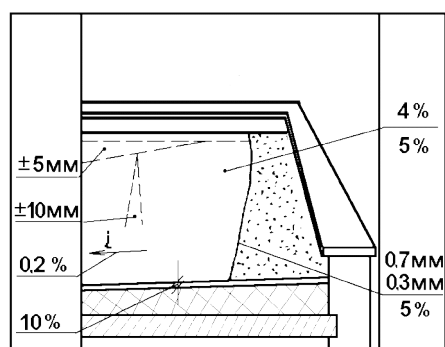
Схема допускаемых отклонений при приемке основания кровли
